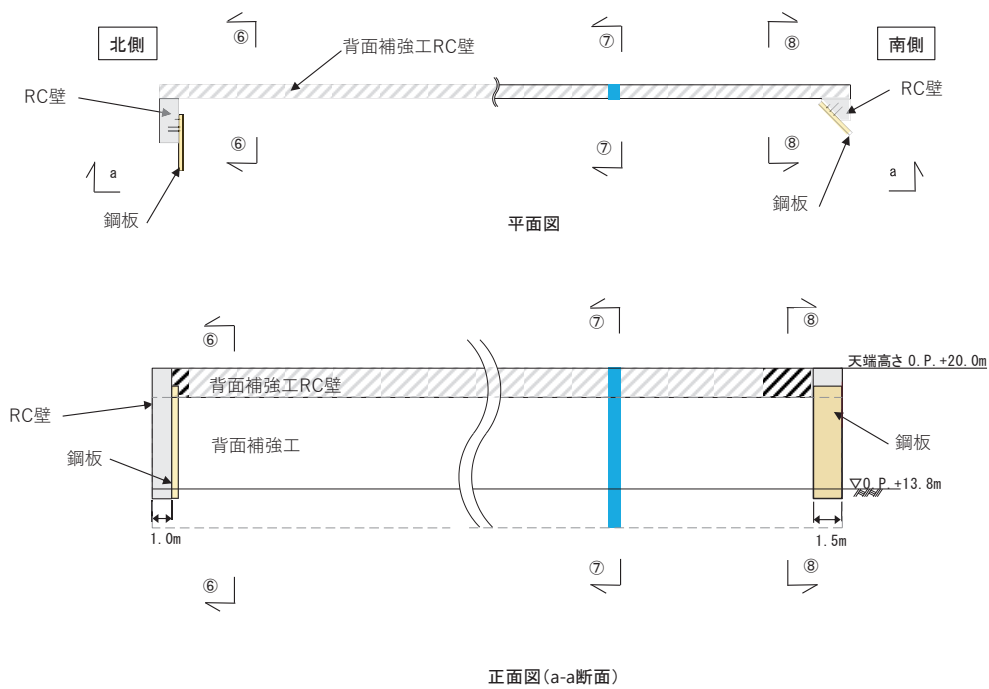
(1) 止水パターン⑥, ⑦, ⑧の構造概要(平面図, 正面図)
